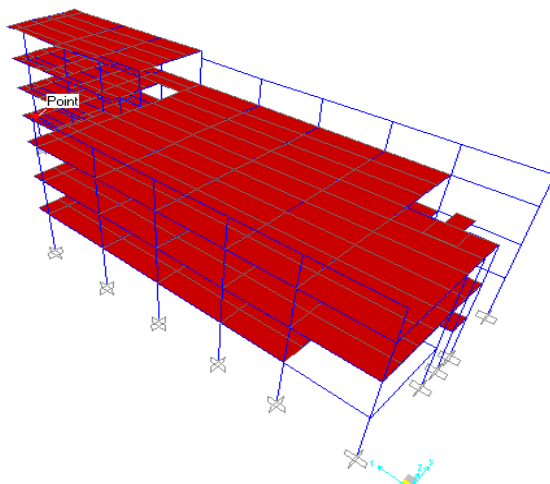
Denah Struktur Perkantoran Bank Permata
